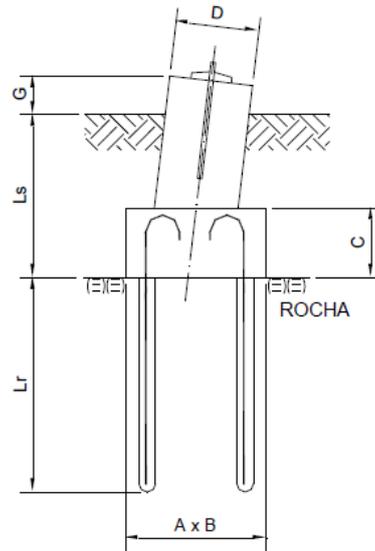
Layout* da fundação tipo bloco chumbado em rocha.
